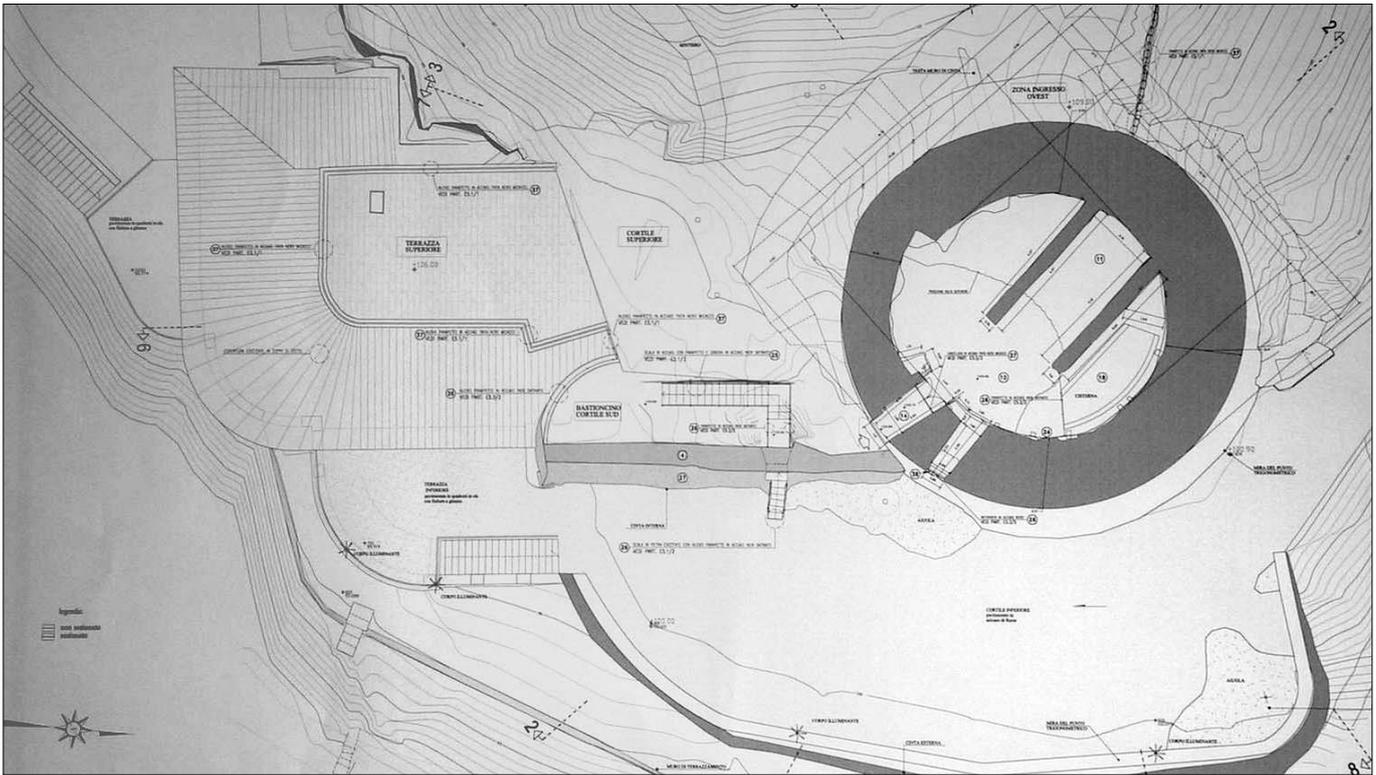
Il "Bastione": progetto di restauro (planimetria generale).
